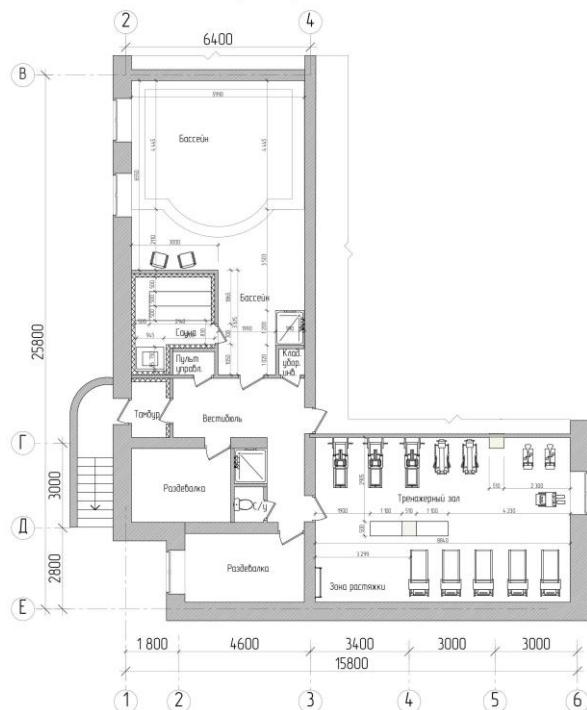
Фрагмент плана с расстановкой мебели цокольного этажа (сауна, бассейн, тренажёрный зал)
